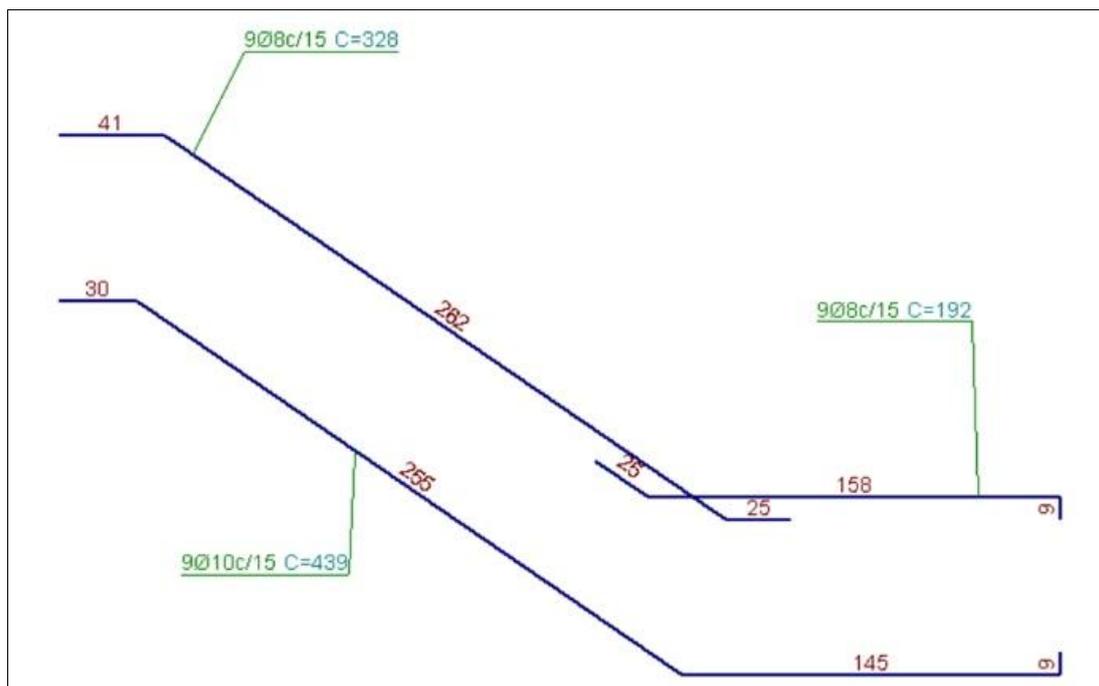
Detalhamento da armadura longitudinal do corte B-B
